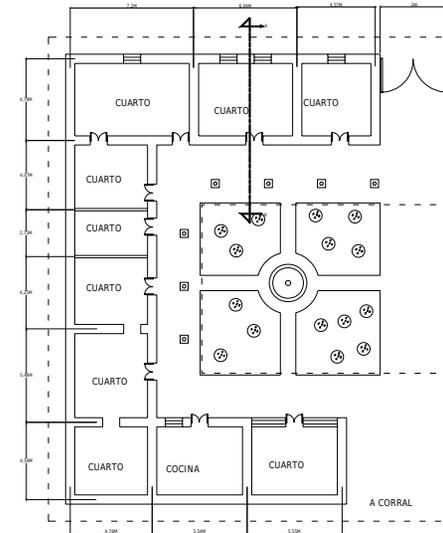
PLANTA ARQUITECTONICA CORRESPONDIENTE A LA FICHA 17.
